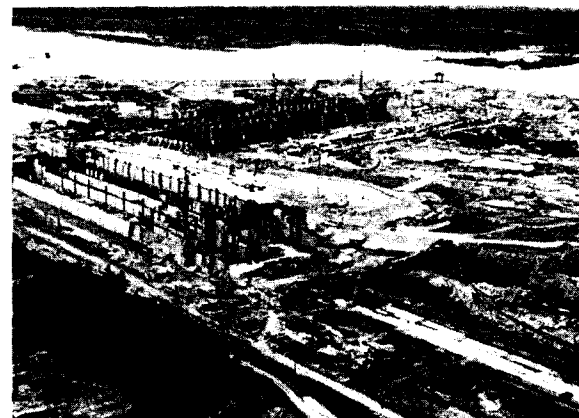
Строительство Чебоксарской ГЭС. Вид на котлован с правого берега
